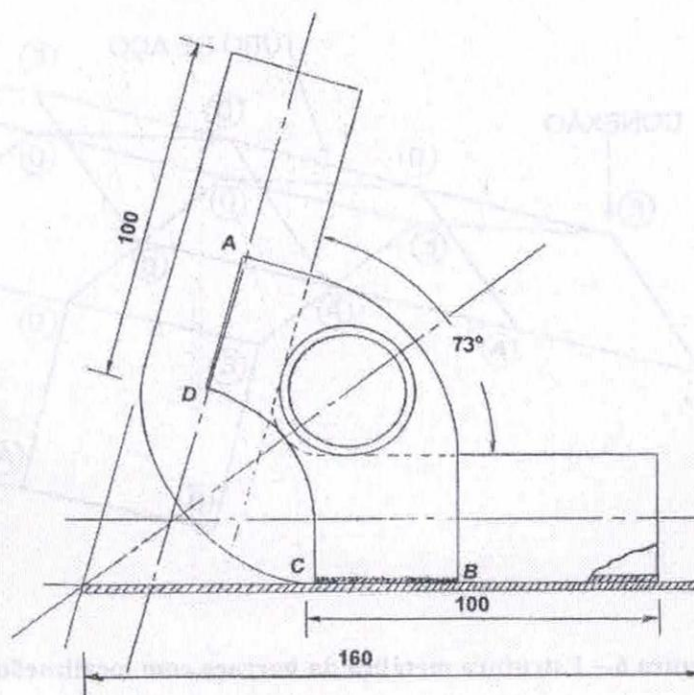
Conexão lateral inferior – uma versão, vista de perfil - localização A, B e C (medidas em mm)
